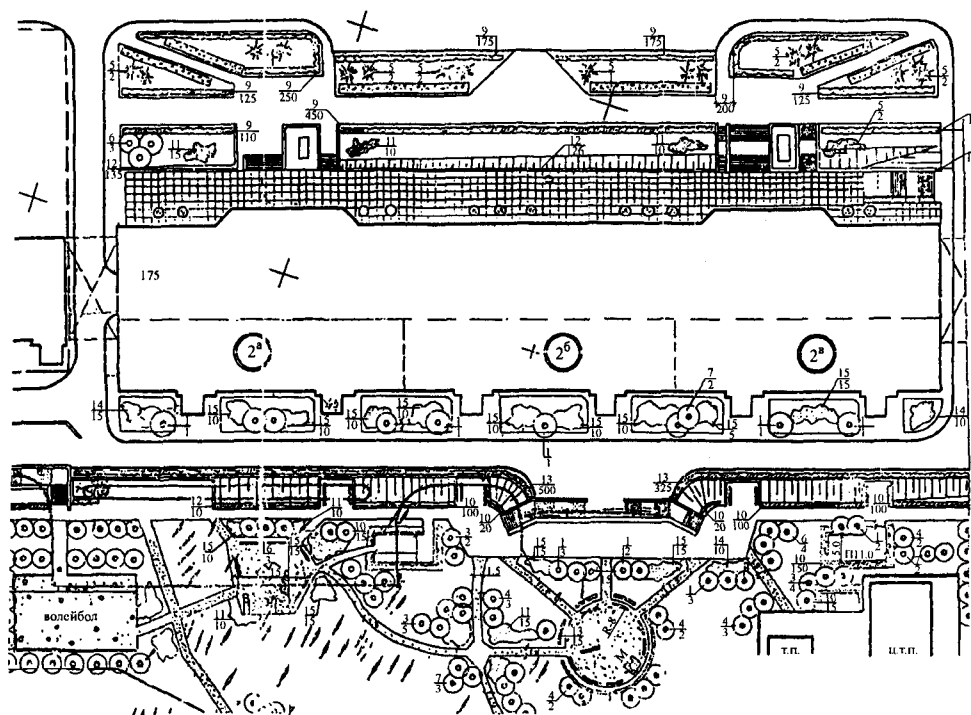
Схема генерального плана дворового участка многоэтажного жилого дома
